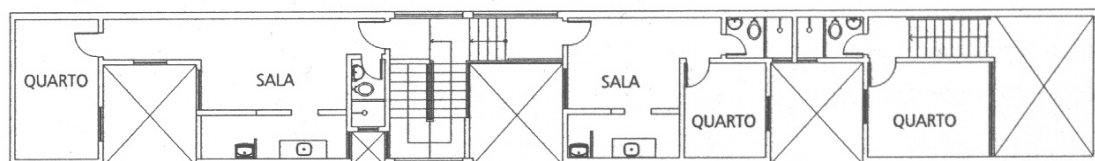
Rua do Livramento, 145 – Planta baixa do segundo pavimento (SECRETARIA, 2000, p. 52).
